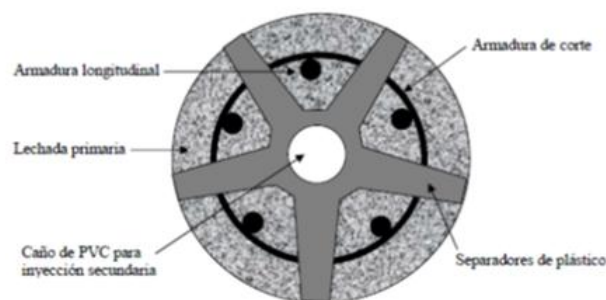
Separadores de plástico tipo estrella para las armaduras.
